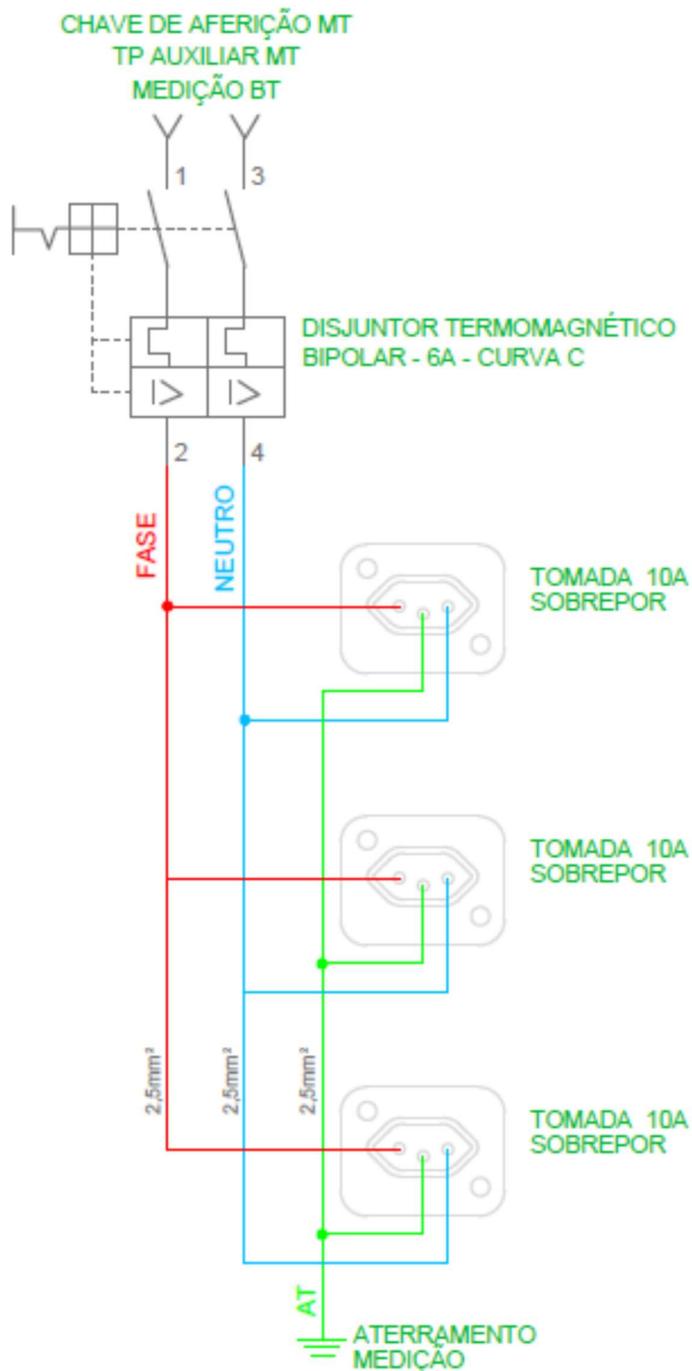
B – Caixa Metálica para Medição Indireta em BT – Montagem dos Equipamentos
